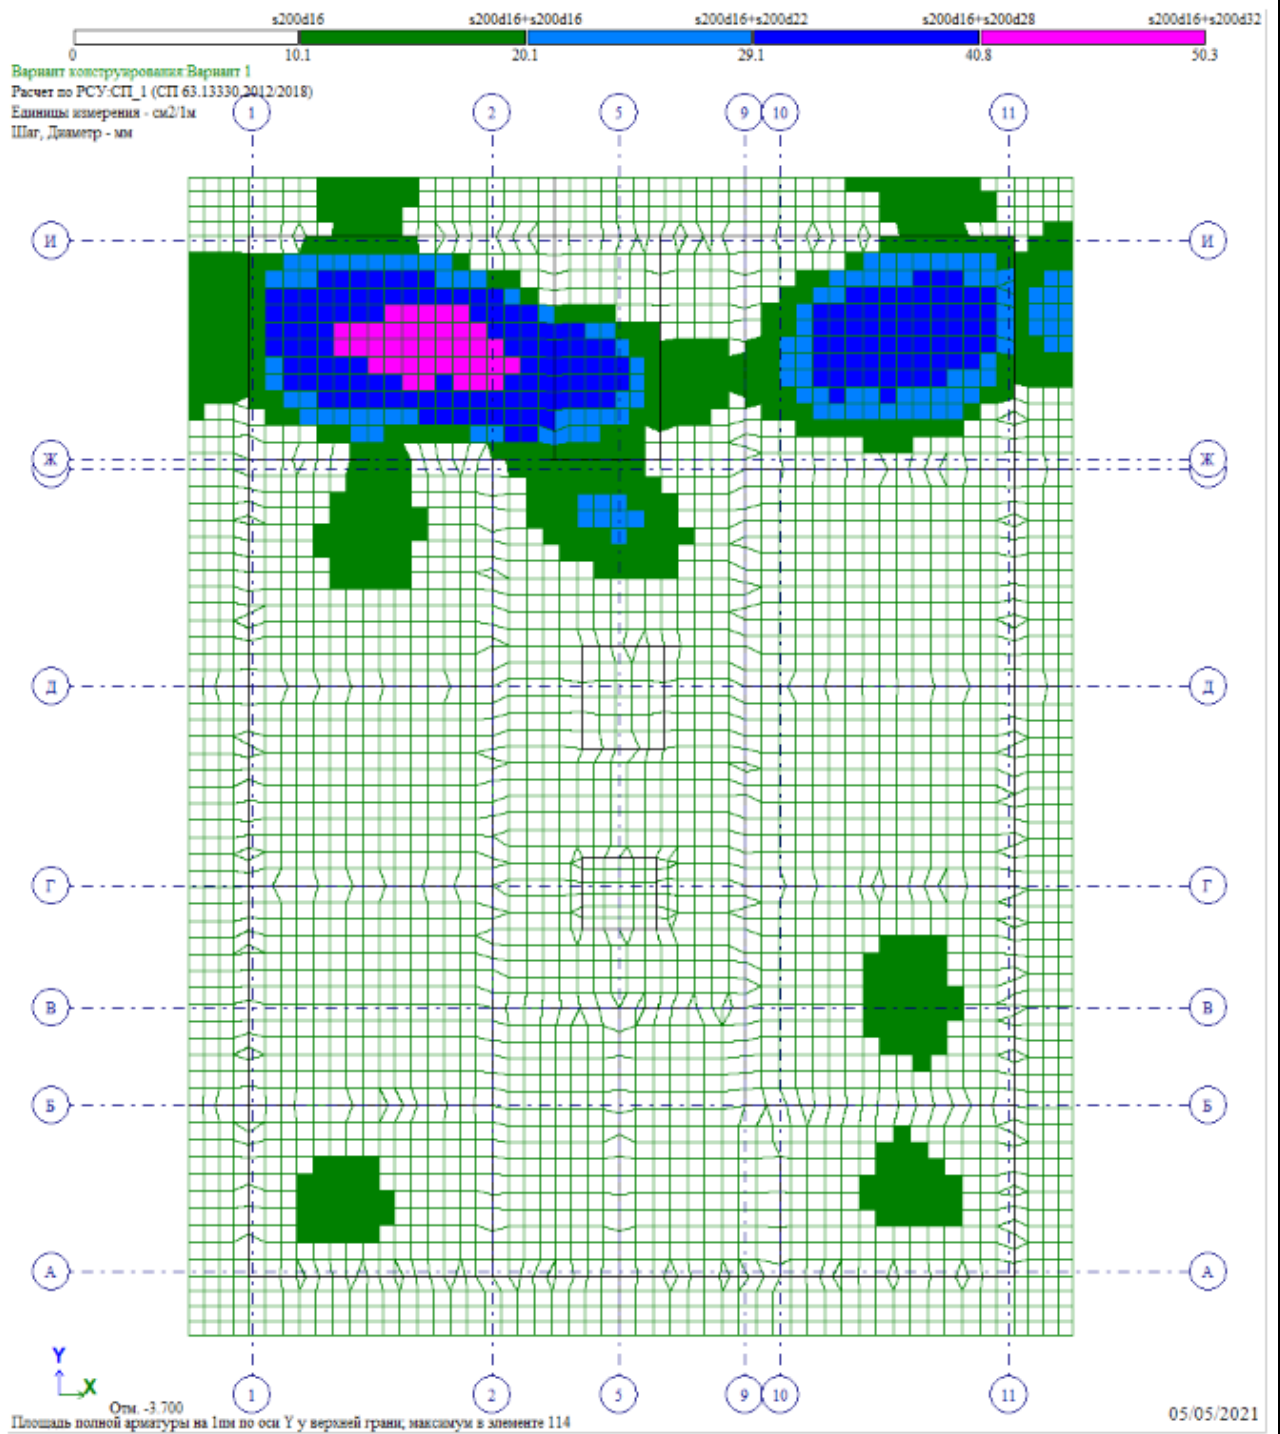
армирование верхней зоны фундаментной плиты по оси Y
